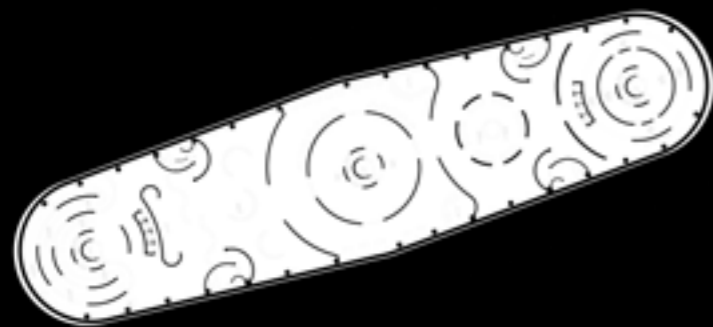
Planta de Subsuelo N-1 (N-4.70).
